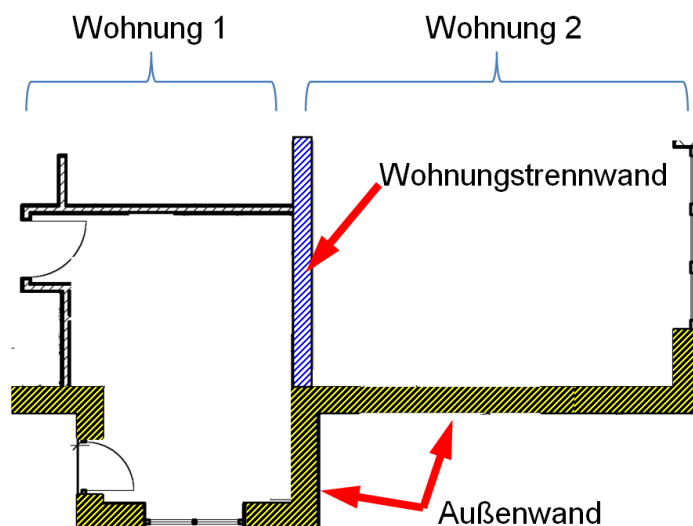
Beispiel versetzter Grundrisse – „abknickende“ Außenwand
